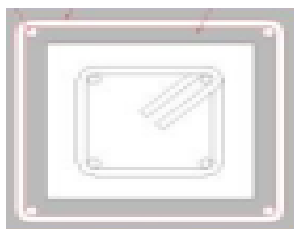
Limpiar las impurezas en la sección de la columna (*Fuente:* AutoCAD 2013)
